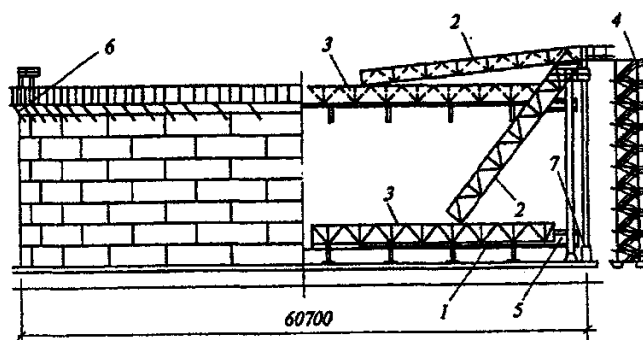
Вертикальний циліндричний резервуар об'ємом 50 тис. м з плаваючою дахом: 1 – плаваючий дах; 2 – сходи; 3 – рейковий шлях; 4 – шахтні сходи; 5 – закриті коробки; 6 – кільце жорсткості; 7 – зазор між стінкою резервуара і понтоном
